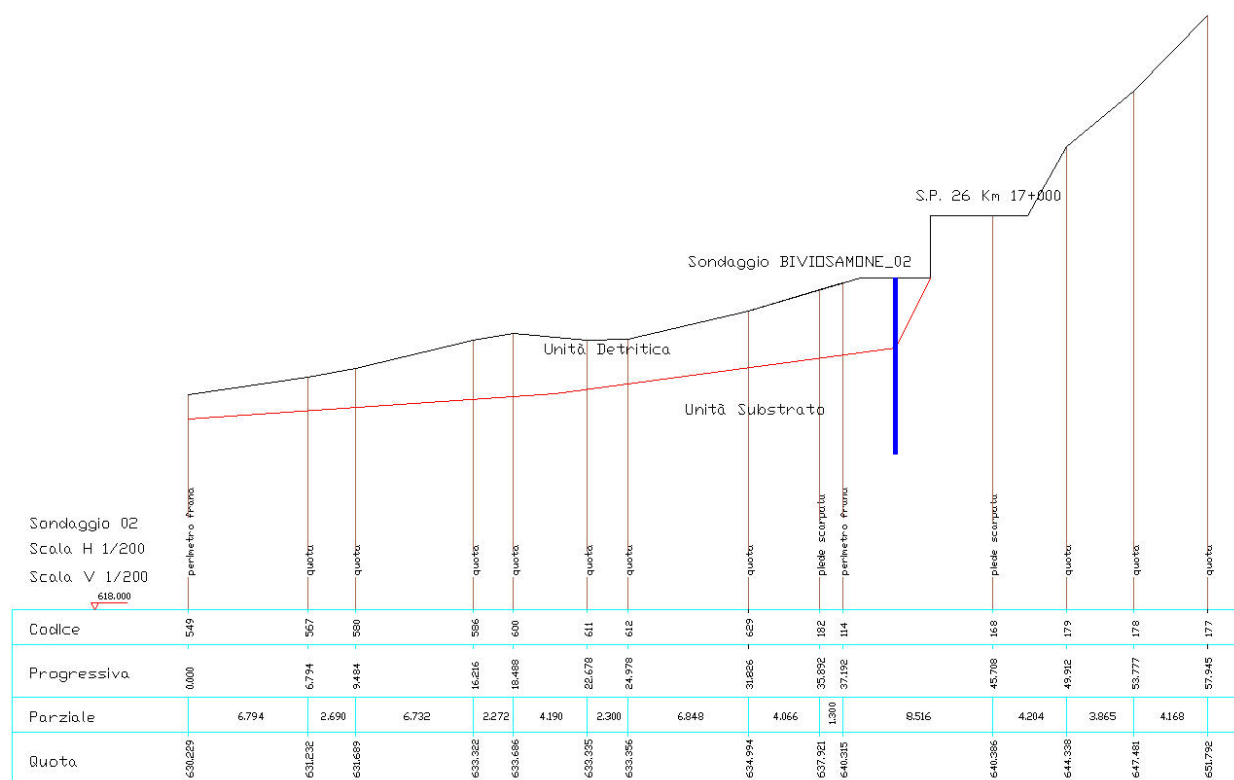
Sezione litotecnica coincidente con la sezione topografica n. 2 (precedente alla realizzazione dei drenaggi)
